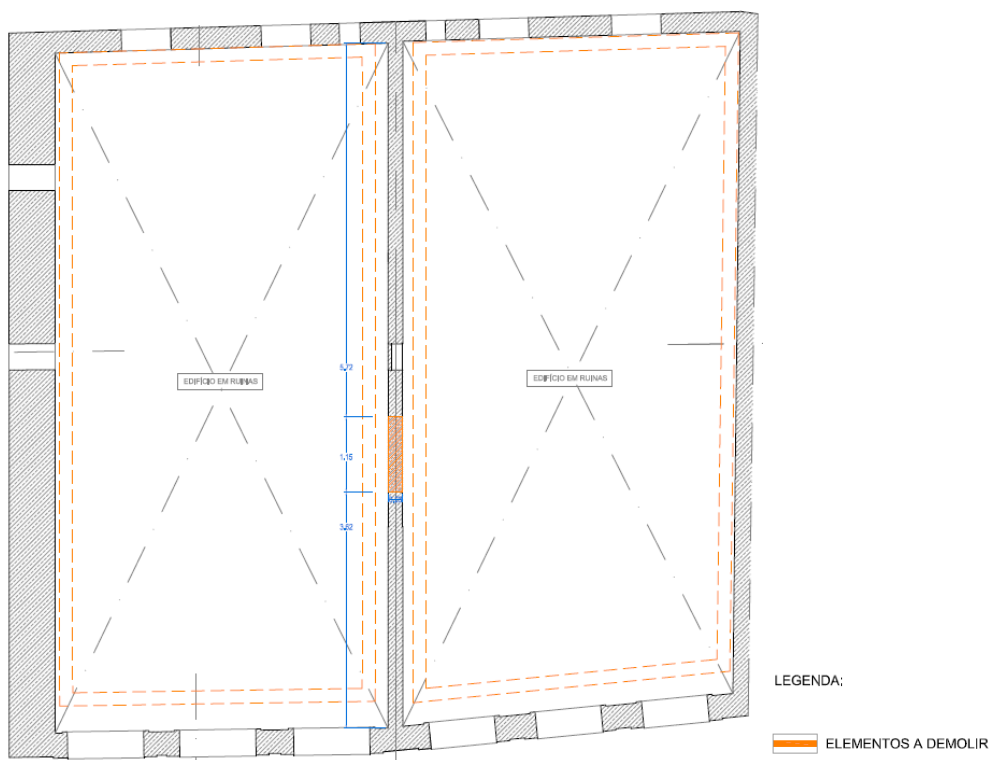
Planta do 3º piso com elementos a demolir - Fonte: Desenhos de Arquitetura da Operação E2 - Projeto 9
